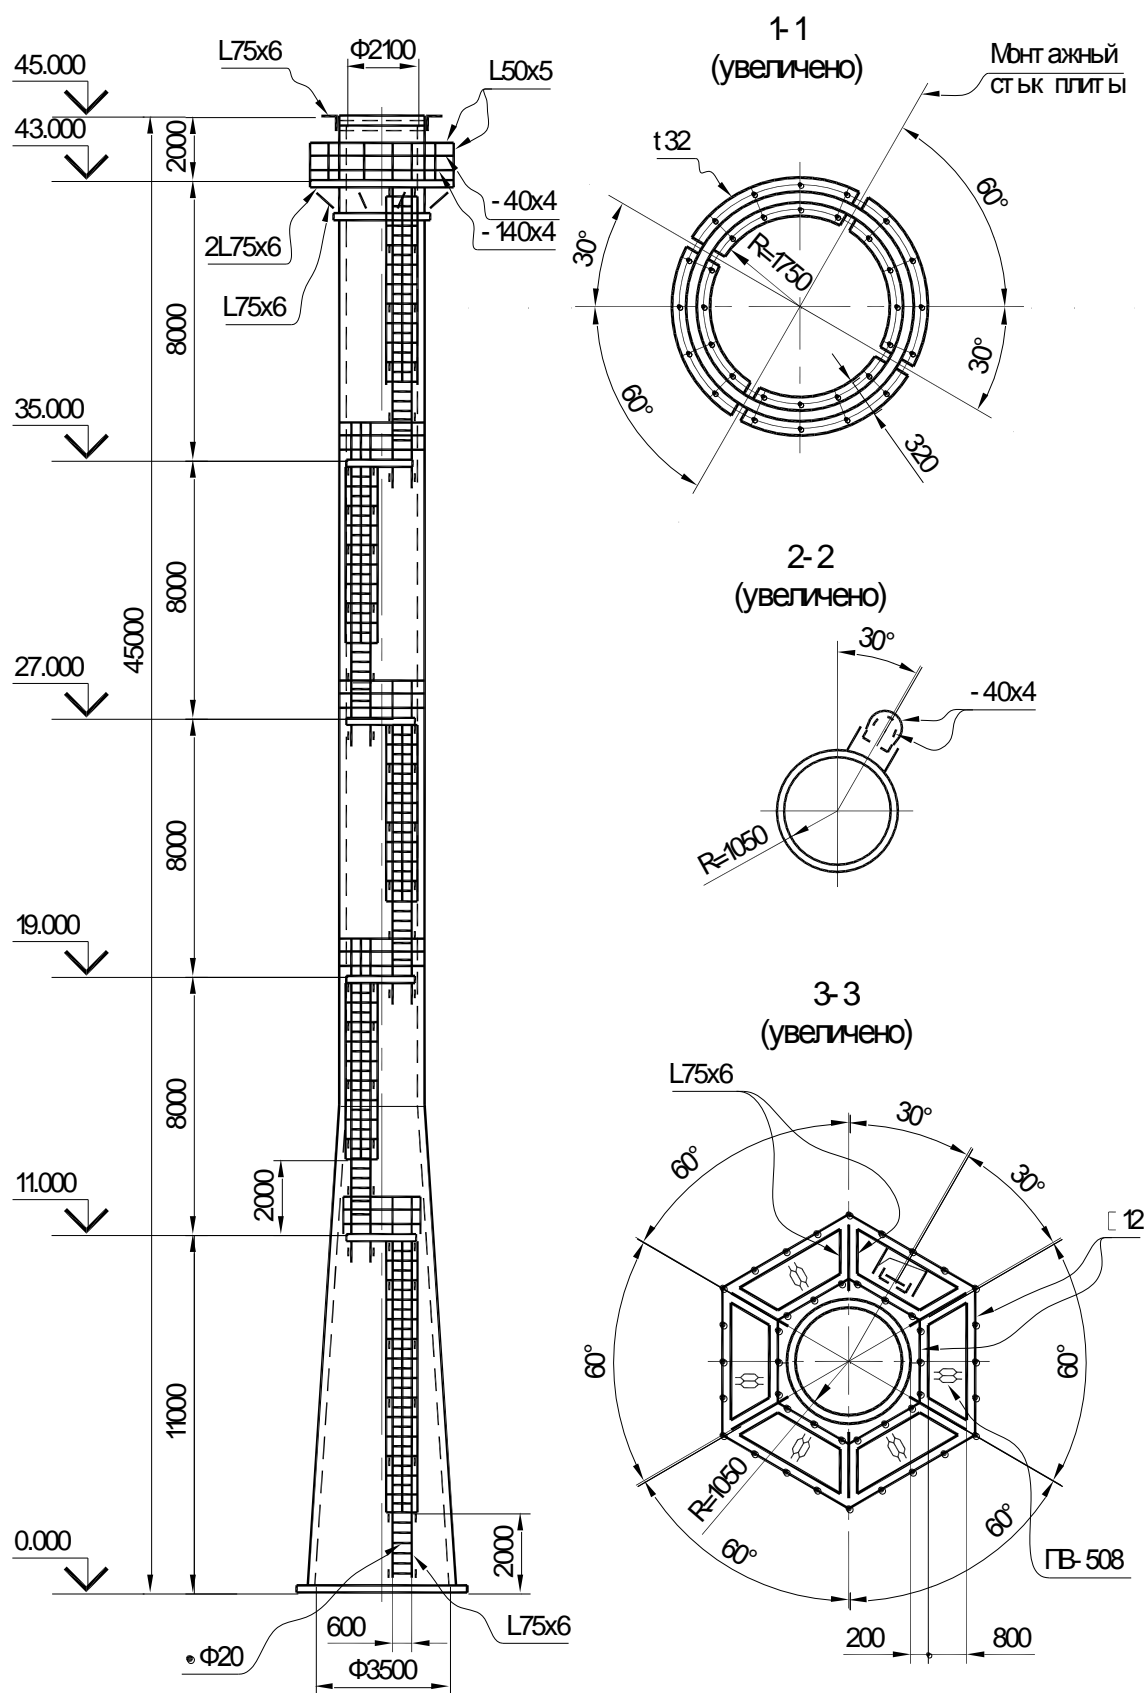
Схема лестниц и площадок дымовой трубы
